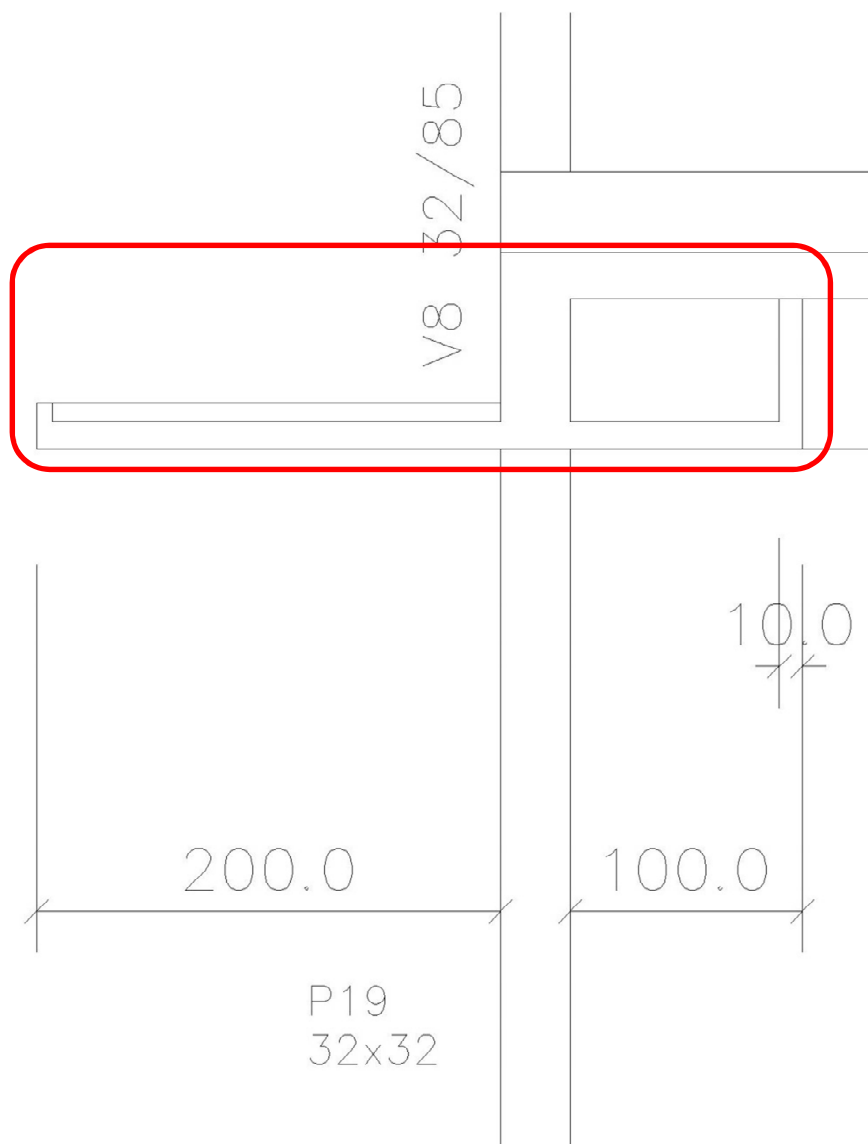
Corte DD do projeto estrutural, marquise localizada a sul da edificação.
